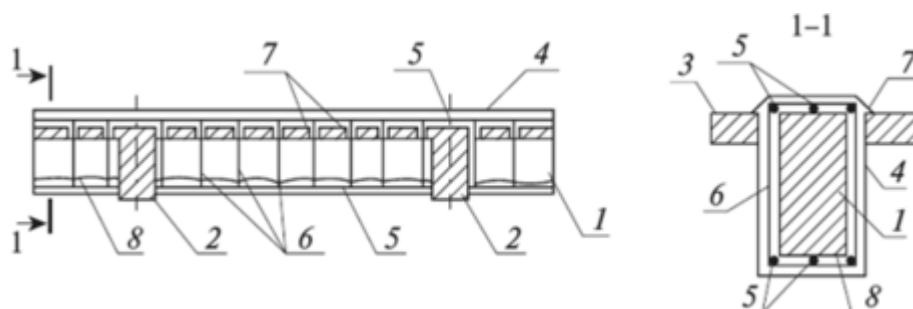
Усиление балок монолитного железобетонного перекрытия устройством железобетонной обоймы: 1 – усиливаемые второстепенные балки; 2 – главные балки; 3 – плита; 4 – железобетонная обойма; 5 – продольная арматура обоймы; 6 – хомуты обоймы; 7 – отверстия, просверленные в плите для пропуска хомутов и укладки бетона; 8 – поверхность балок, подготовленных к бетонированию
